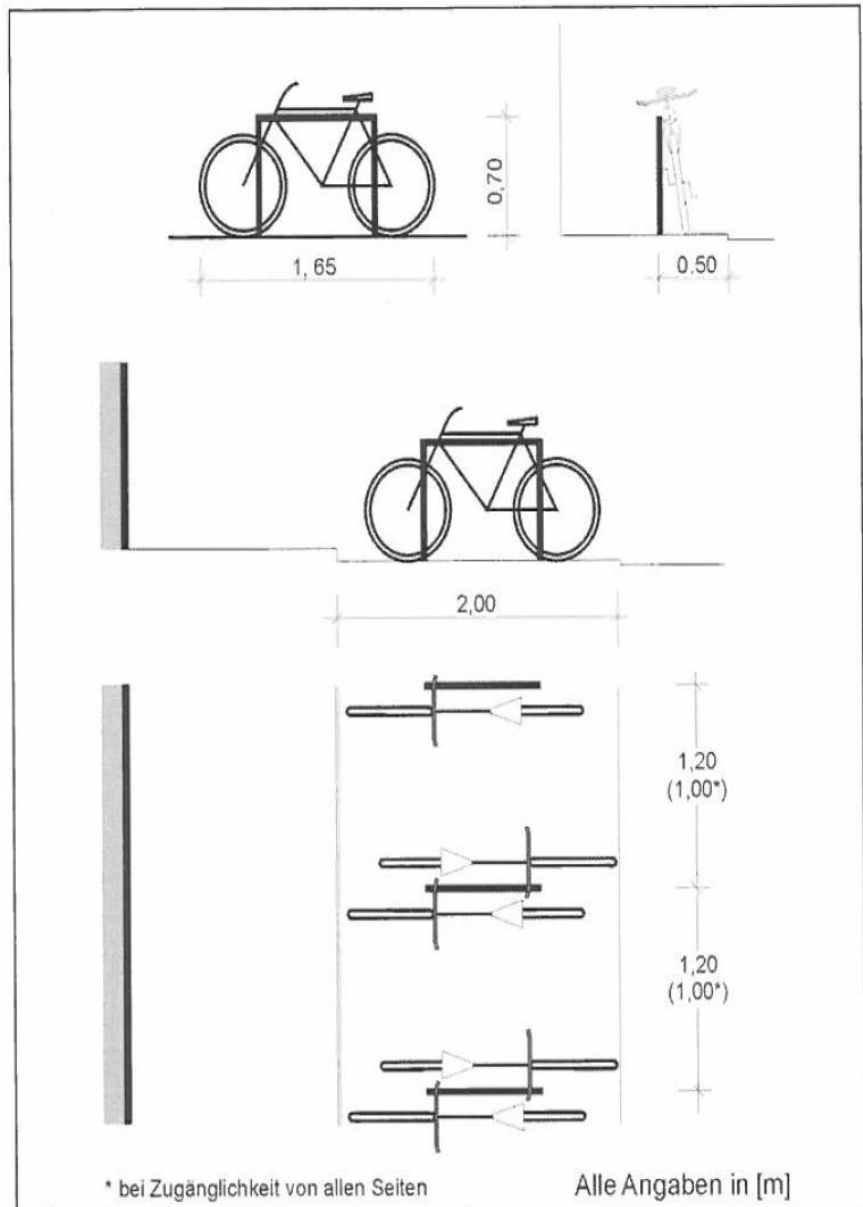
Grundmaße von Abstellanlagen für Fahrräder
